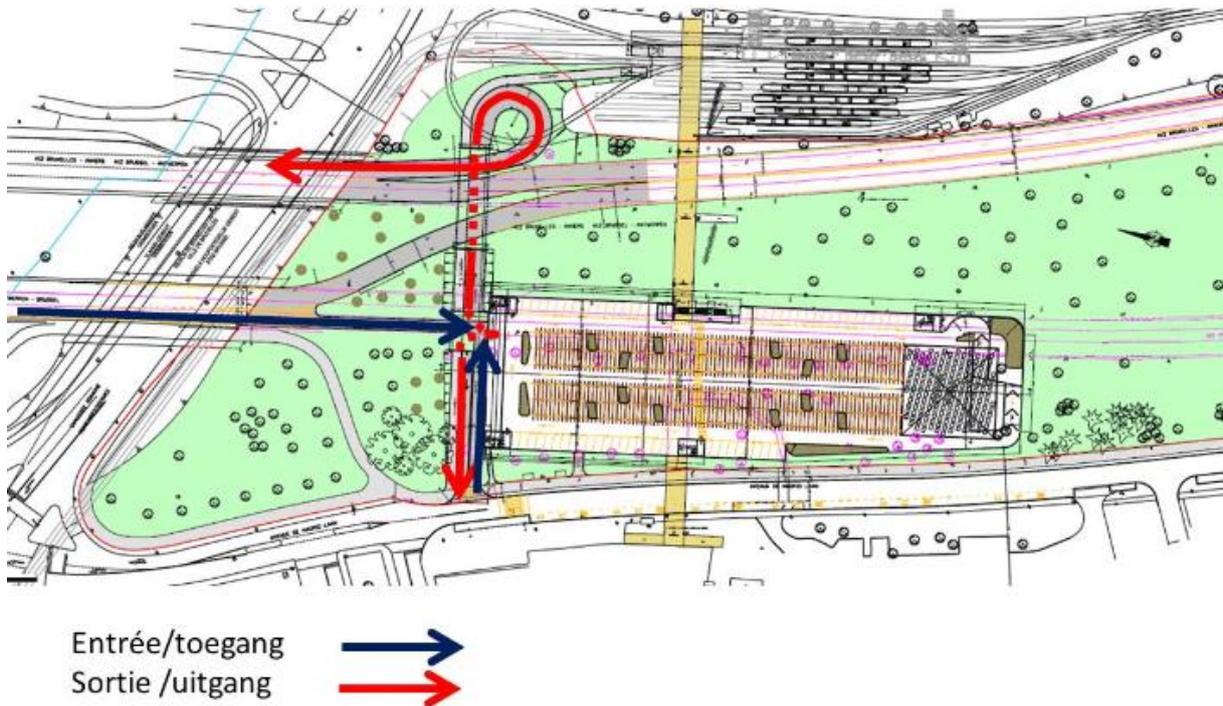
Implantation du bâtiment de parking (Mai 2018)
